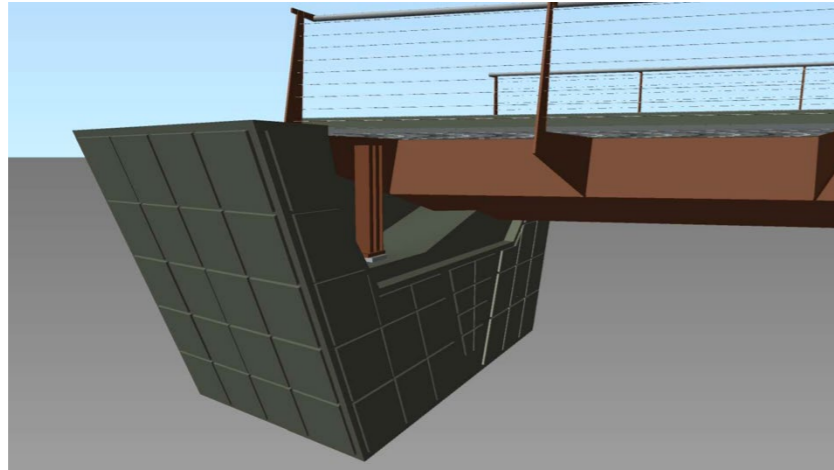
Vista en 3D del estribo. Fuente: Elaboración propia.
